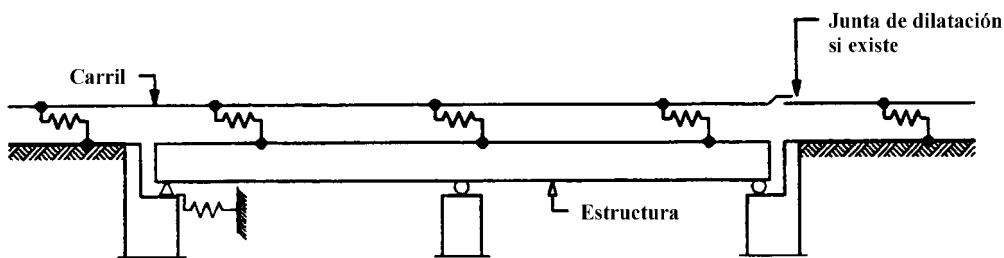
Modelo para estructuras definido en (5) a)
